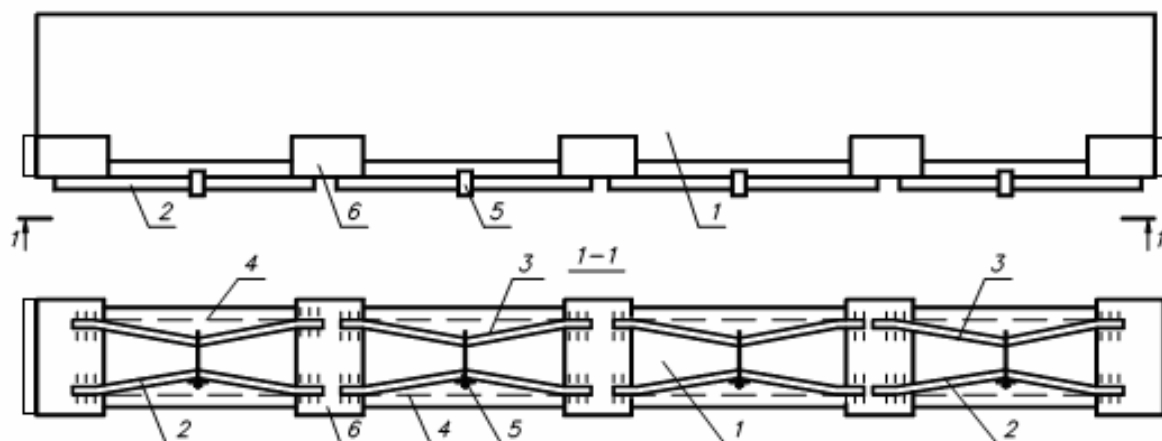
Усиление большепролетной конструкции затяжкой: 1 – усиливаемая конструкция, 2, 3, 4 – стержни затяжки, 5 – стяжной болт, 6 – анкерное устройство
